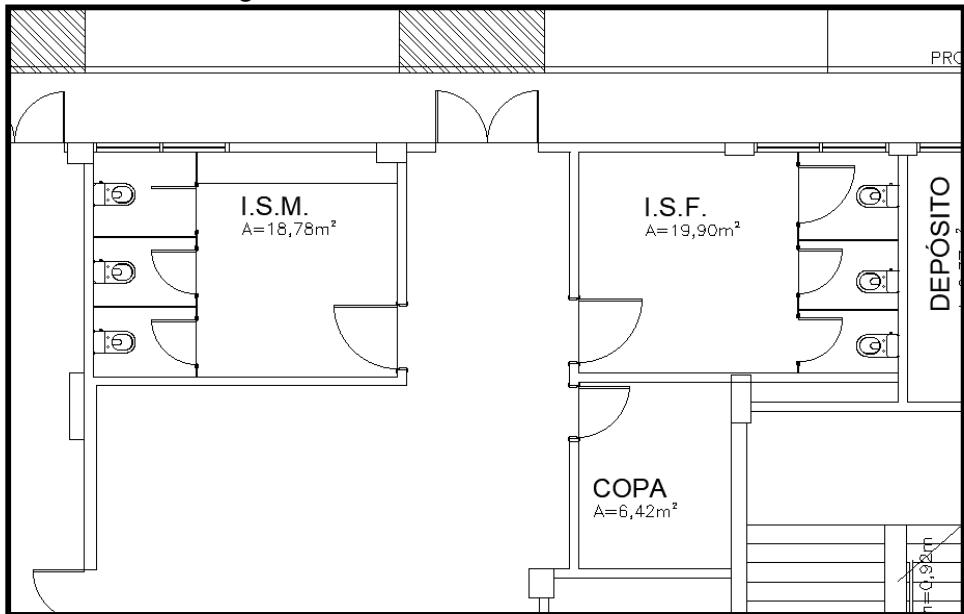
Layout – Sanitários Nível 01 – Proposta
